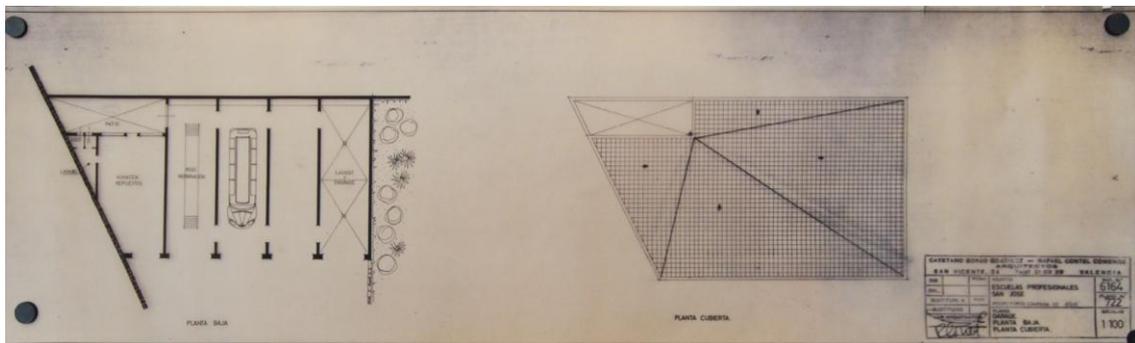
Planta y cubierta garajes. *Archivo Escuelas San José.
